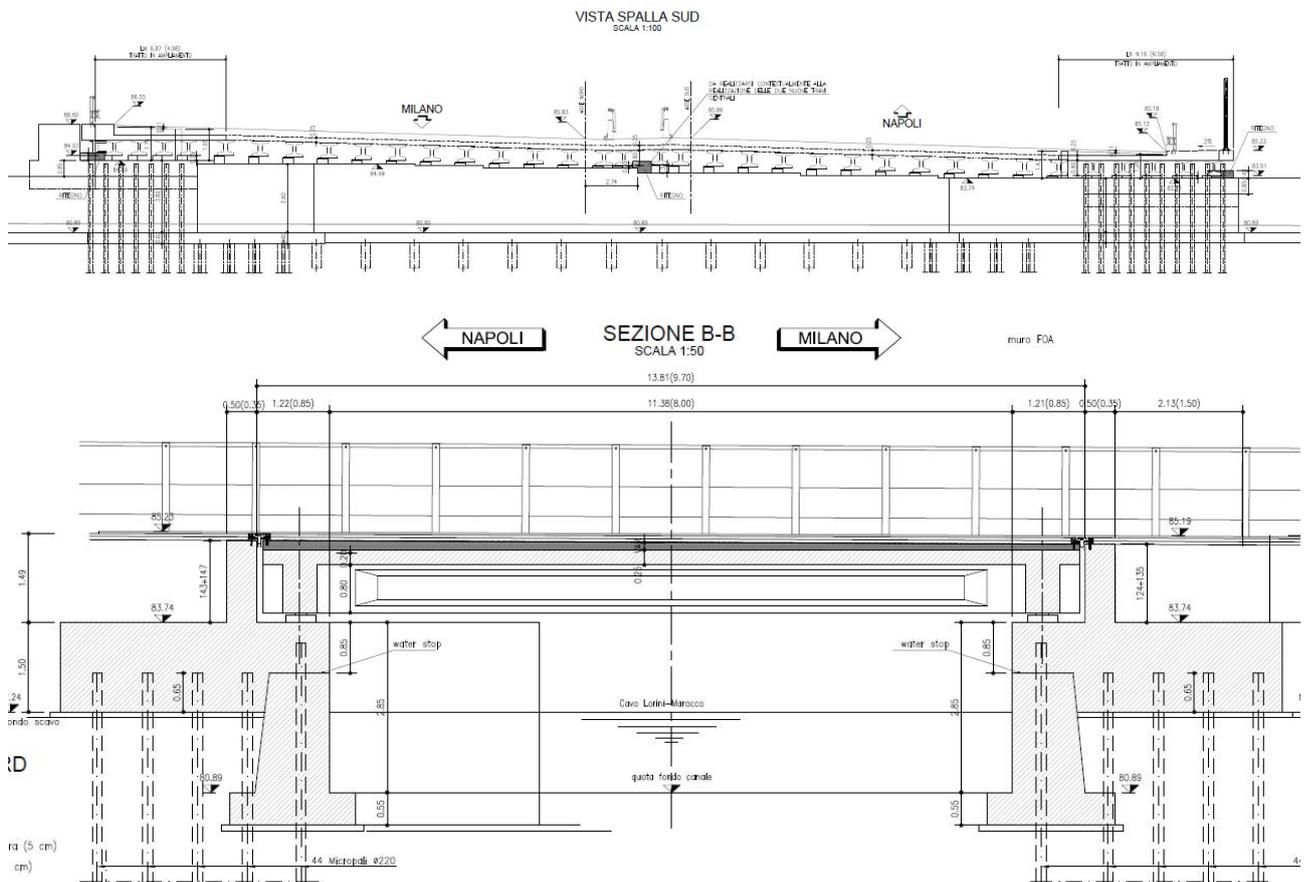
Cavo Lorini Marocco - Sezione trasversale e longitudinale
